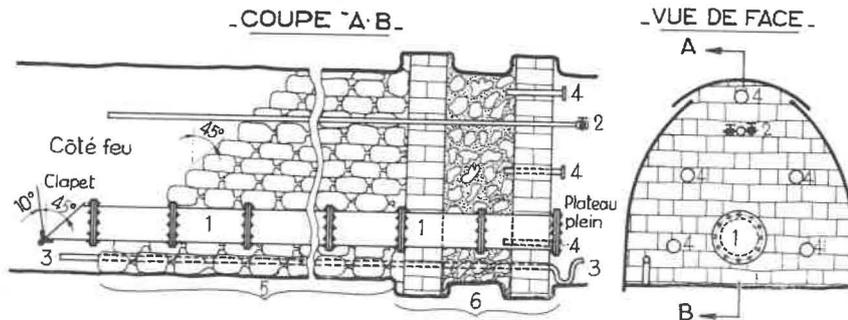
Avant-barrage et barrage d'étanchéité. — Cas des chantiers grisouteux. Retour d'air. Atmosphère à température supportable.
